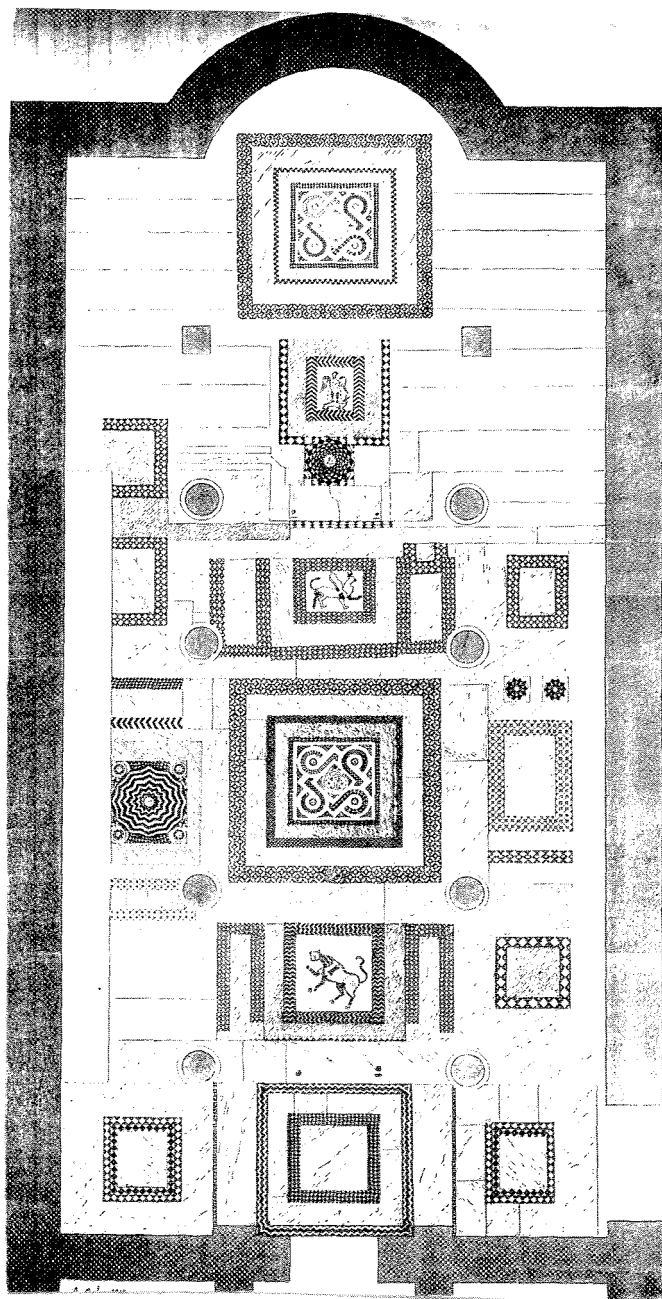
Varnakova, pianta del pavimento (da A.K. Orlandos, 1922).
